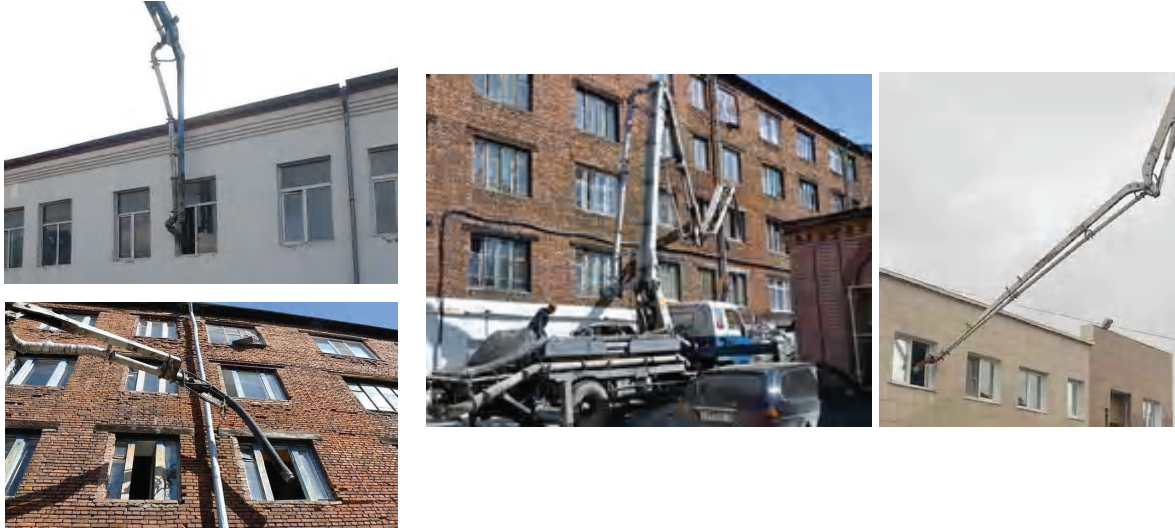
Подача бетонной смеси автобетононасосом через оконный проем.
